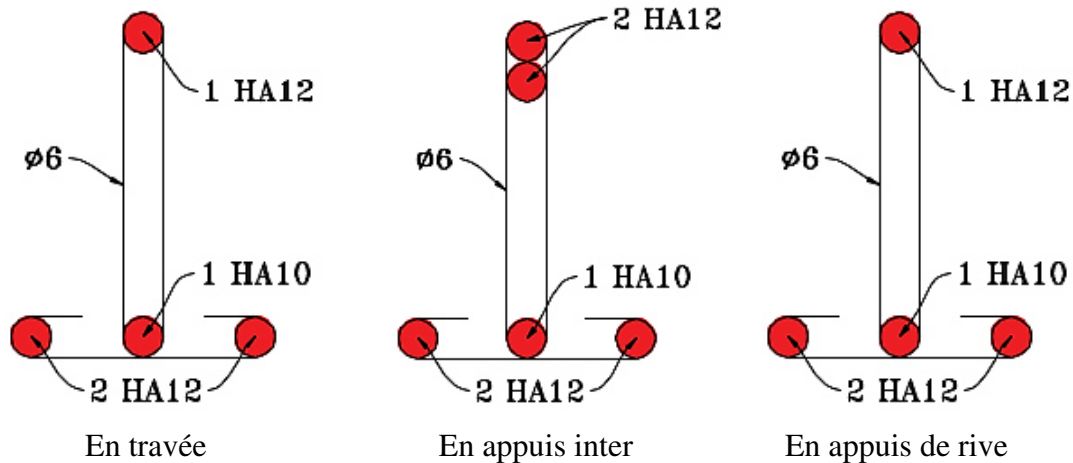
Schémas de ferrailage des poutrelles du RDC.
